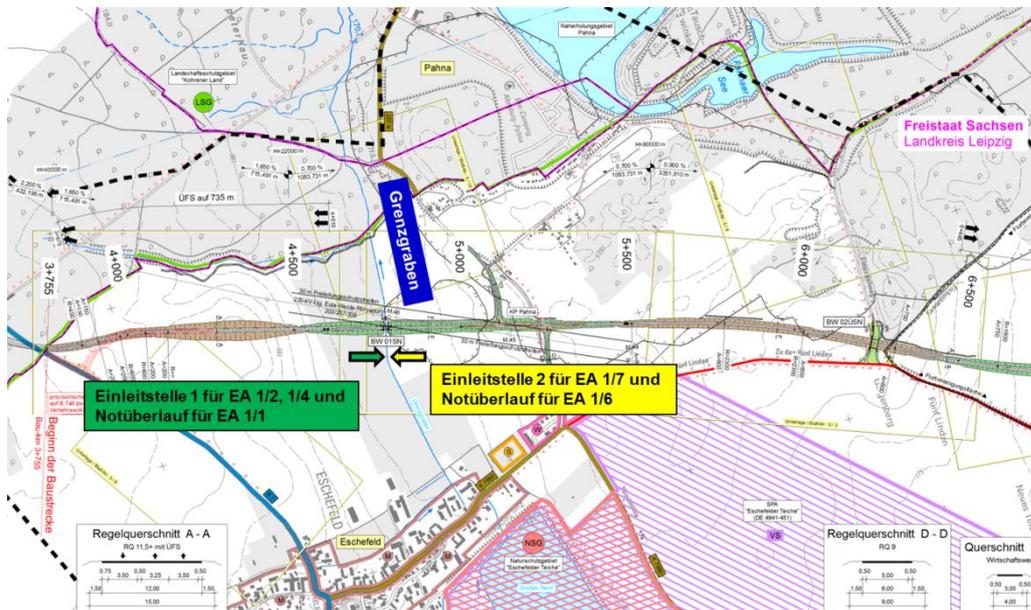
Potenziell betroffene Oberflächenwasserkörper im trassennahen Bereich des Planungsvorhabens (verändert nach DELTA-PLAN 2018b)
